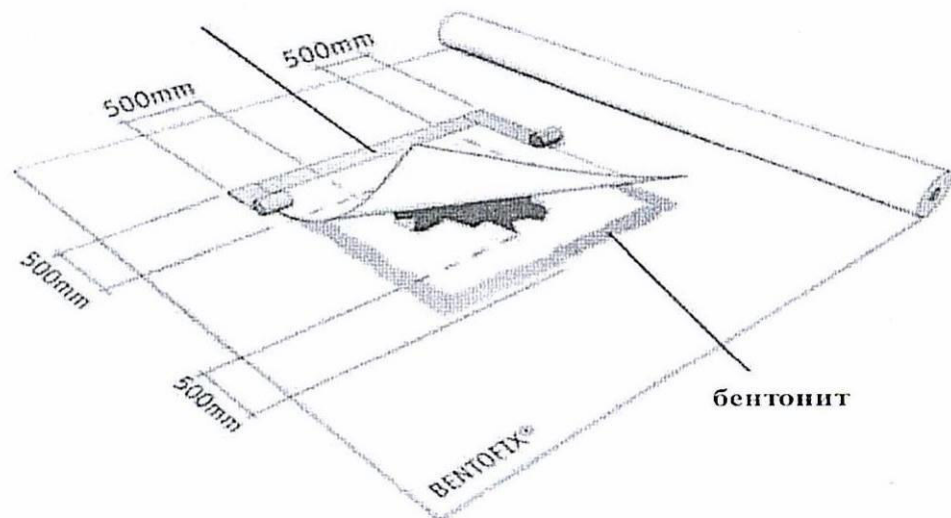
Схема устранения повреждения бентонитовых матов Пригрузочный слой грунта.
